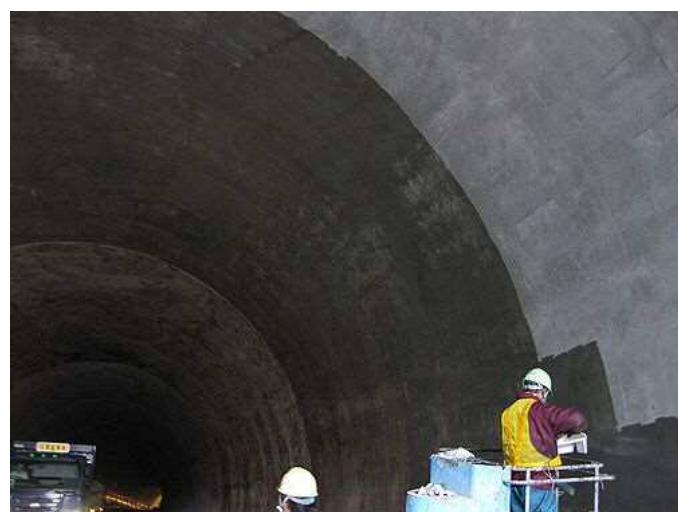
トンネル覆工コンクリートへの施工事例<sup>28)</sup>
